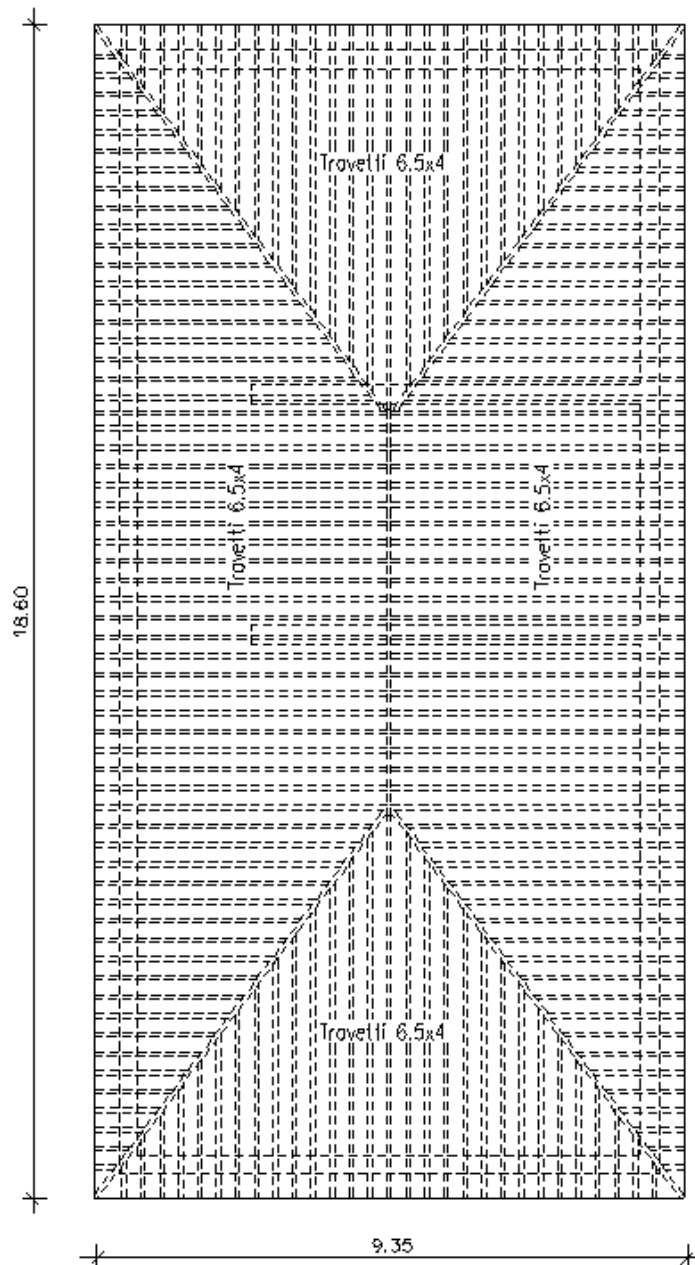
Ex-Lavanderie - stato di progetto: pianta disposizione travetti
